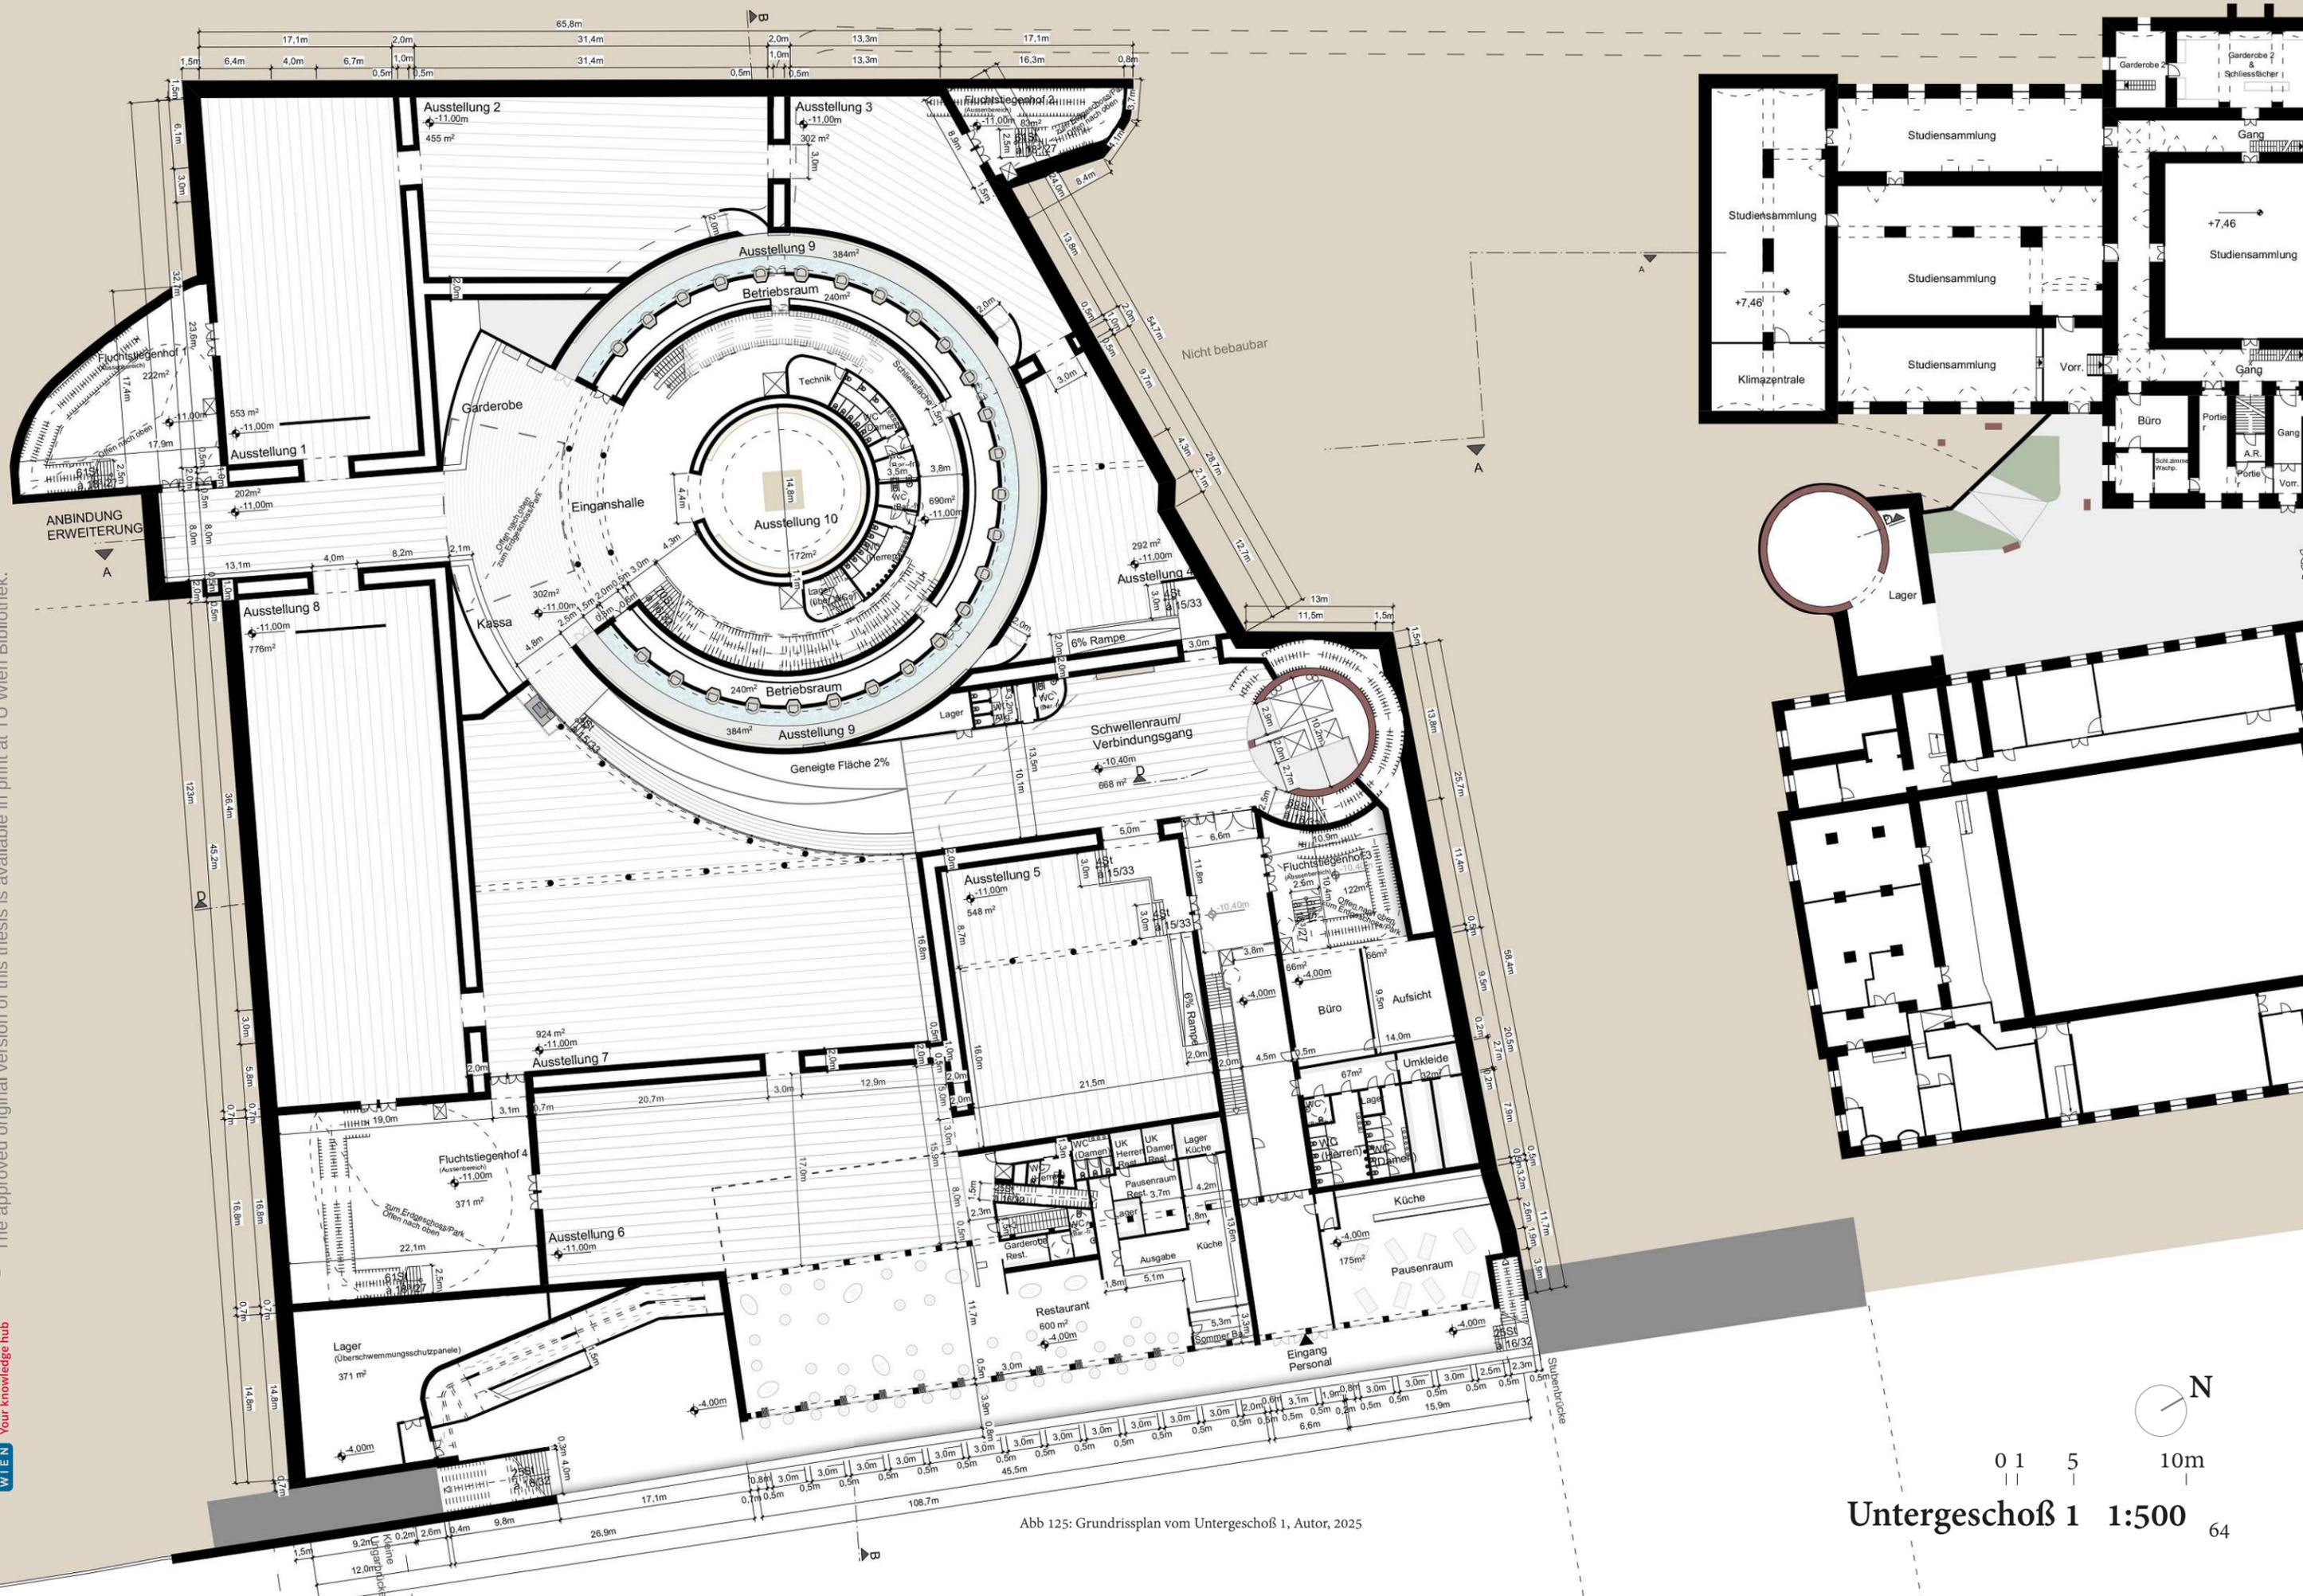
Grundrissplan vom Untergeschoß 1, Autor, 2025
